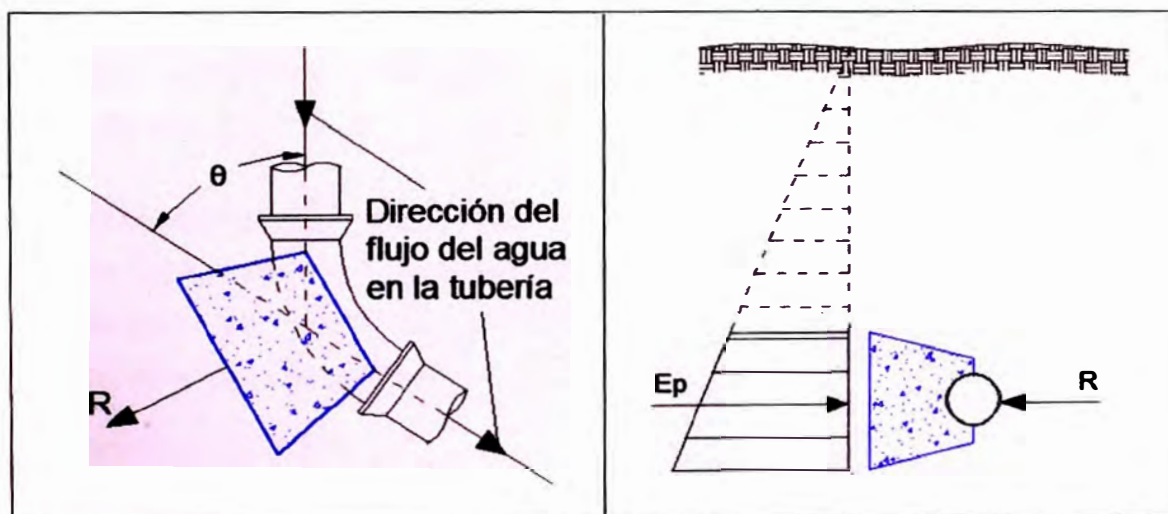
Izquierda: Vista de planta de un bloque de anclaje típico para un cambio de dirección θ . Derecha: Vista de perfil transversal de un bloque de anclaje cuando actúa en empuje pasivo (E_p).
